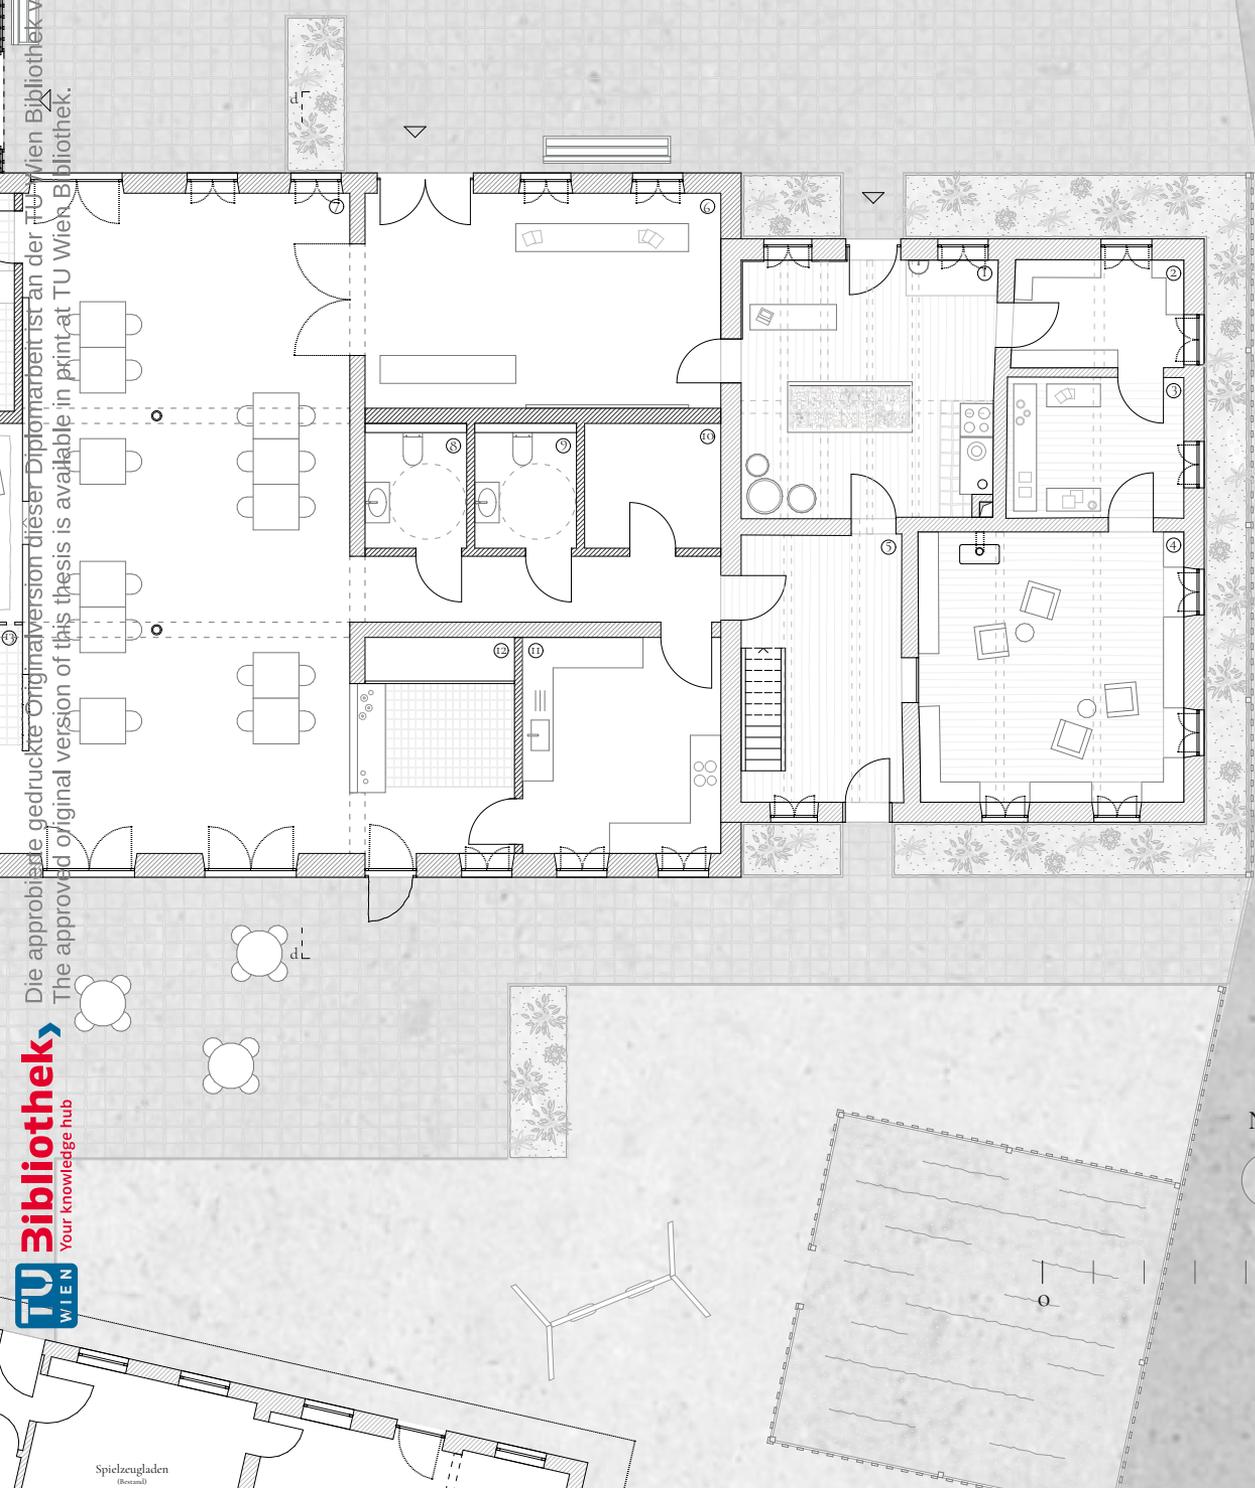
Grundriss Erdgeschoss, M 1:150
